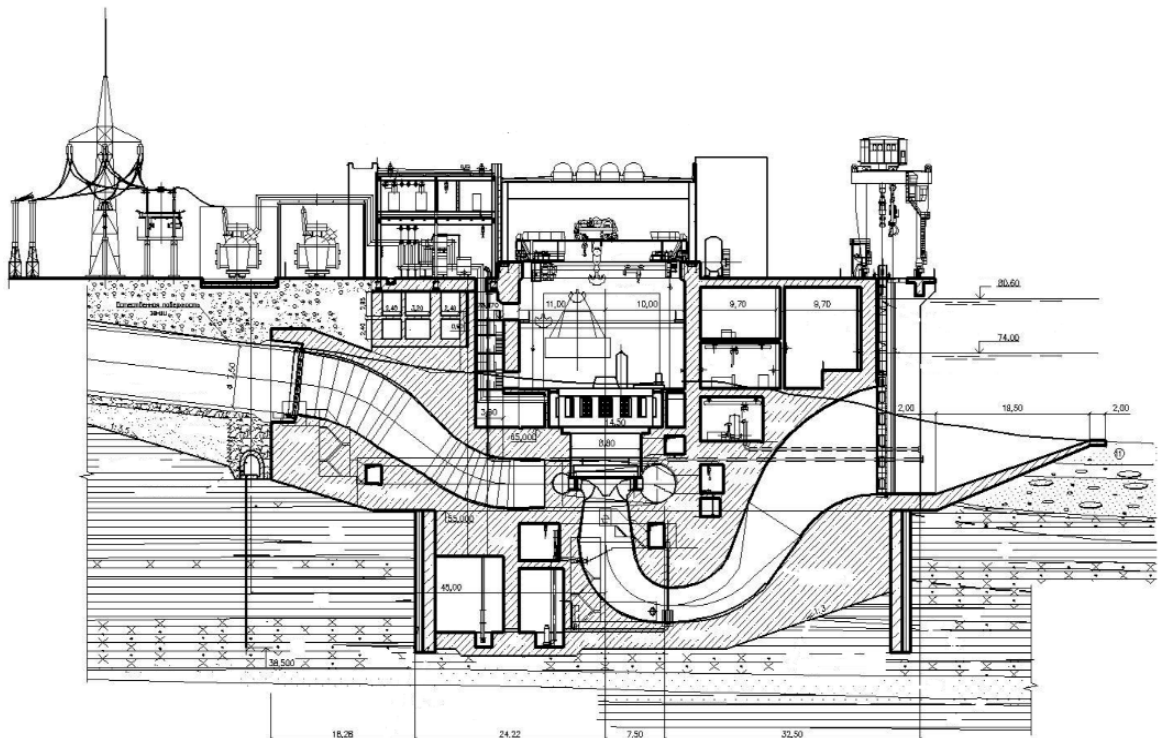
Поперечный разрез по зданию Ленинградской ГАЭС на нескальном основании
